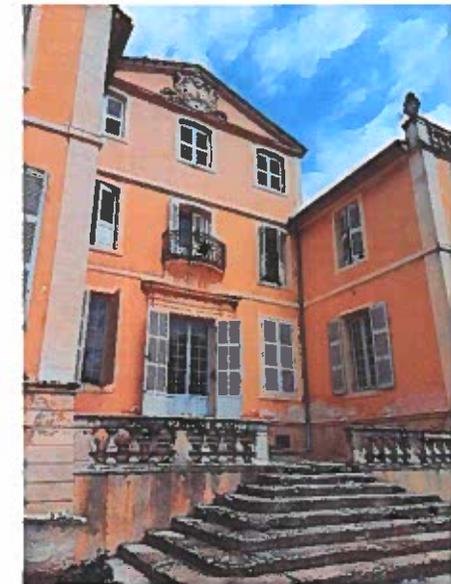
Désorganisation des maçonneries de l'escalier extérieur, photo BMI
